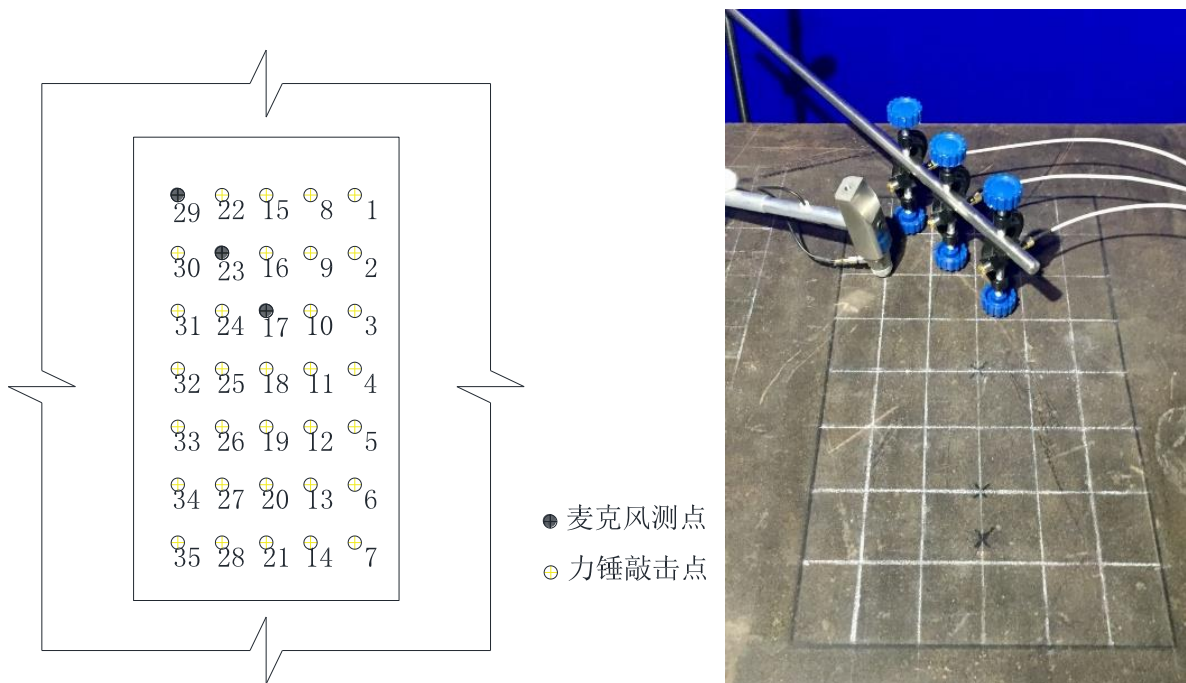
钢-混凝土组合板构件声模态测试测点布置图
